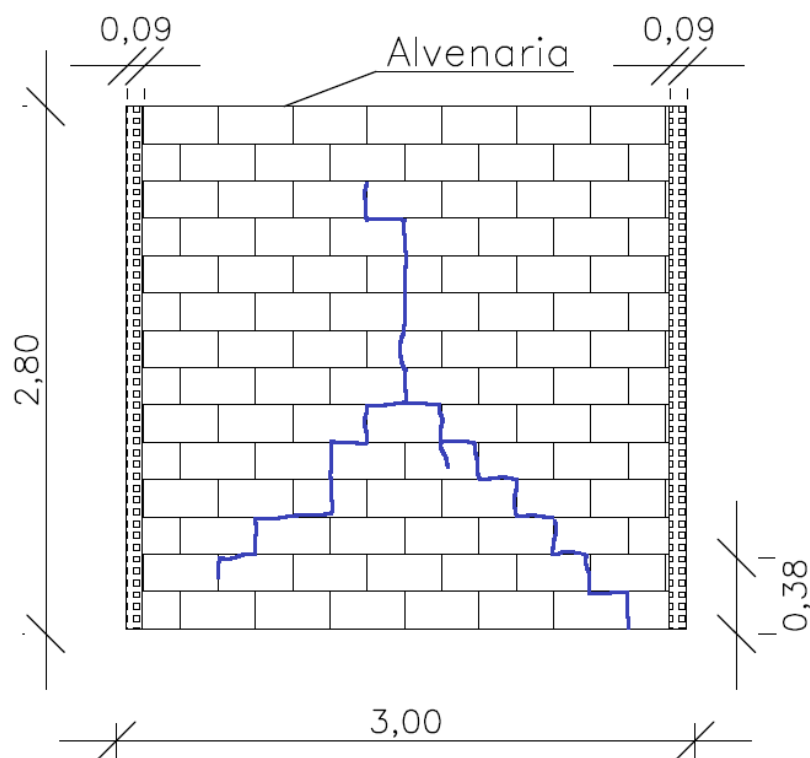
Mapeamento de fissuras da ALV – 2 (Vista frontal)
